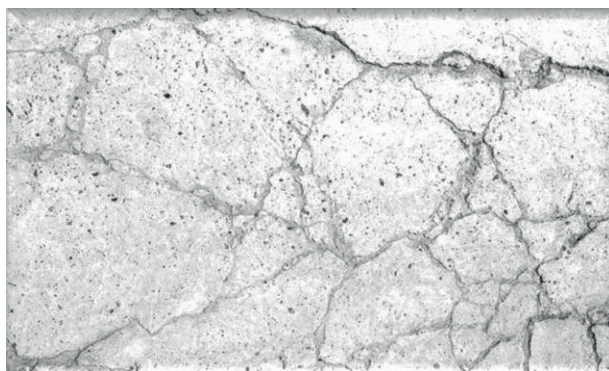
Fissuras de retração por secagem. (Anapre, 2016).
